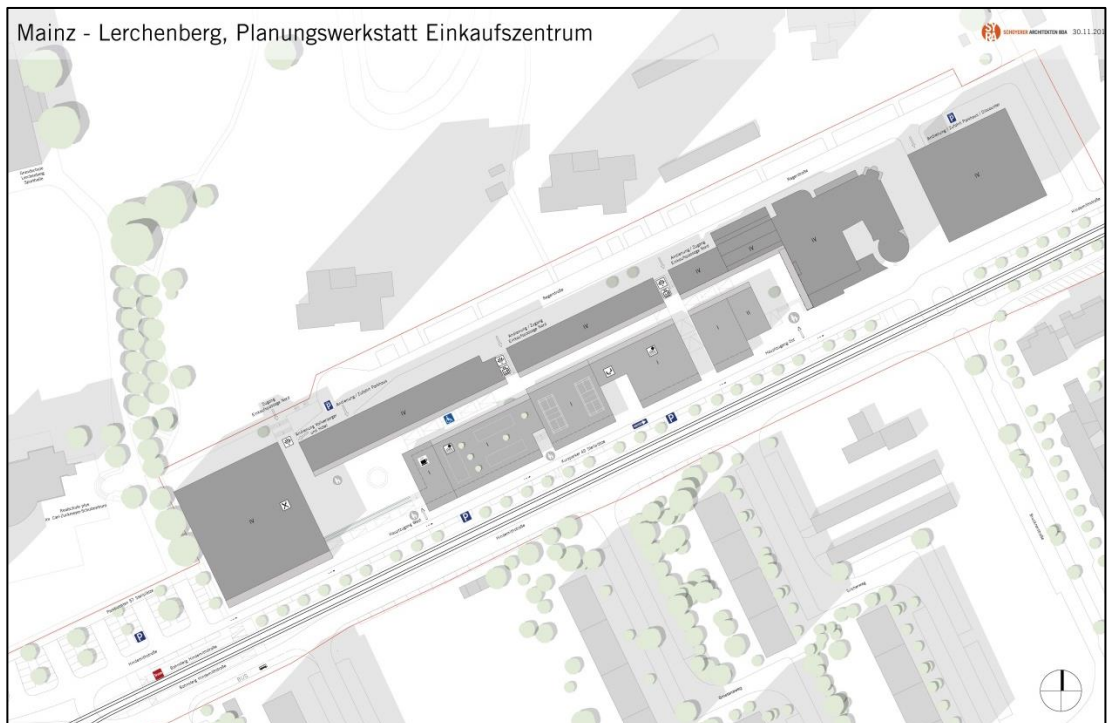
Ergebnis der Planungswerkstatt - Lageplan des Büros SCHÖYERER ARCHITEKTEN_SYRA, Stand: 2015
